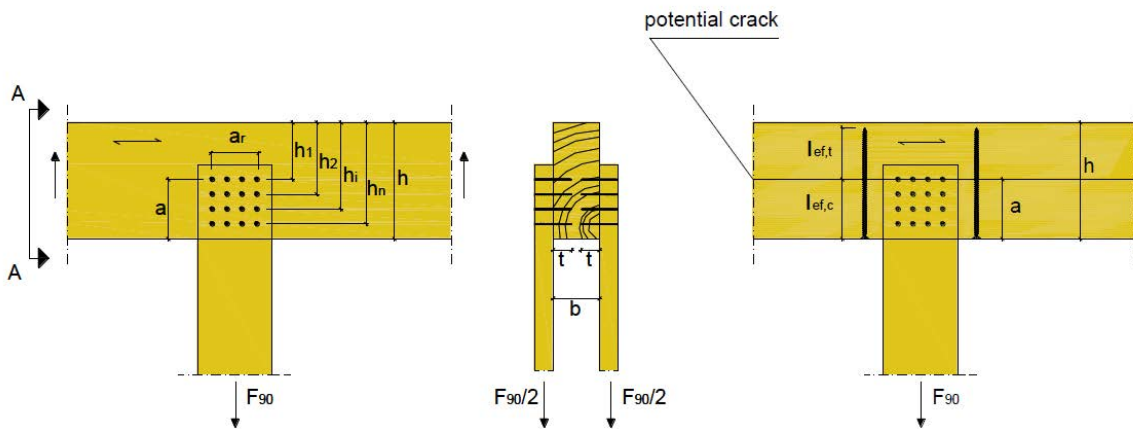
Exemple de renforcement d'un raccordement transversal
